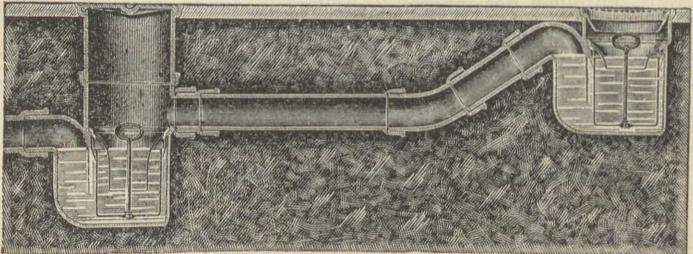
Fettfang in Verbindung mit einem Fußbodeneinlauf.
